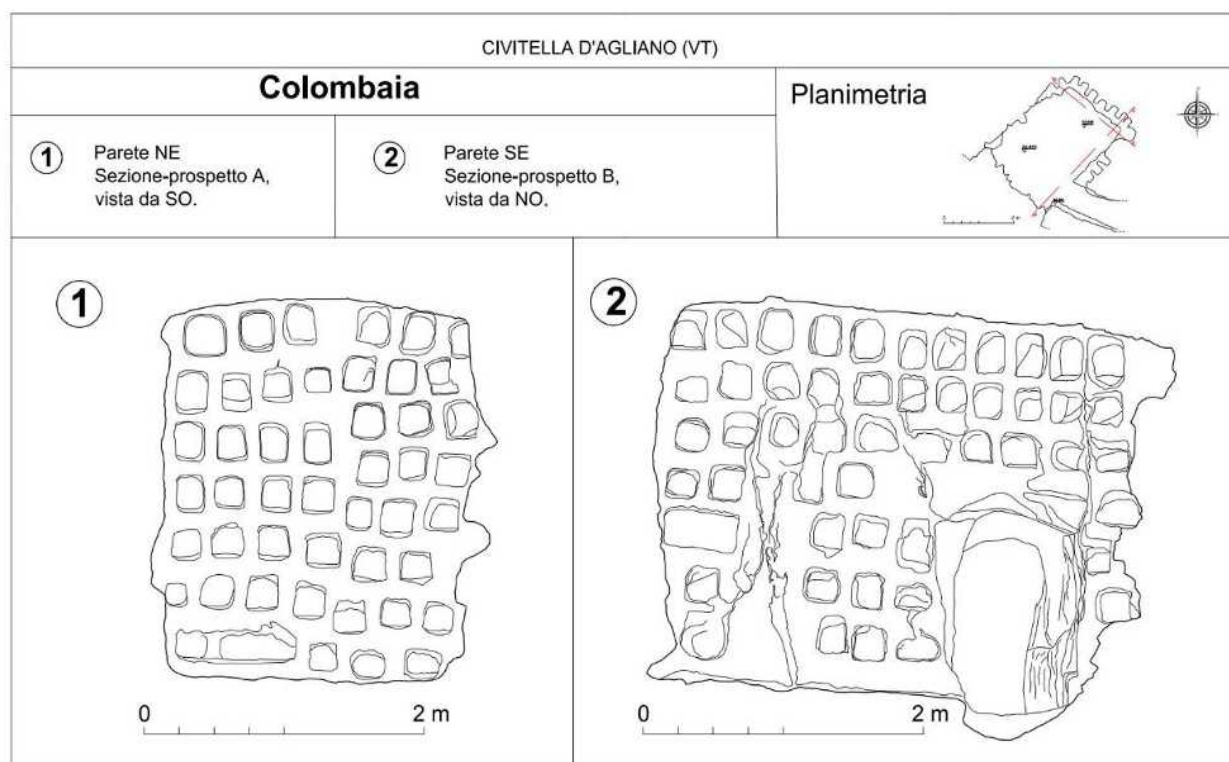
Colombaia. A sinistra, sezione prospetto della parete NE; a destra, sezione prospetto della parete SE.
